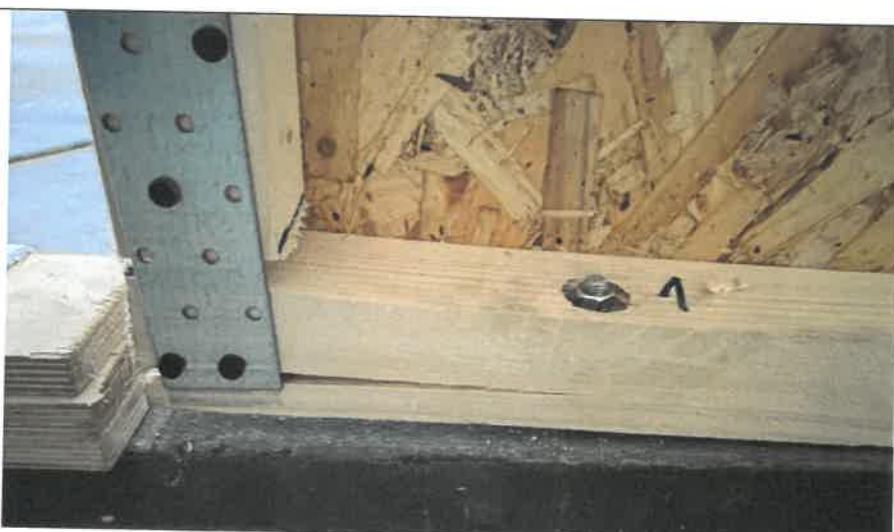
Нижний брус образца с обшивкой ОСП-3 КАЛЕВАЛА тип OSB-3 сломан при максимальной нагрузке.
